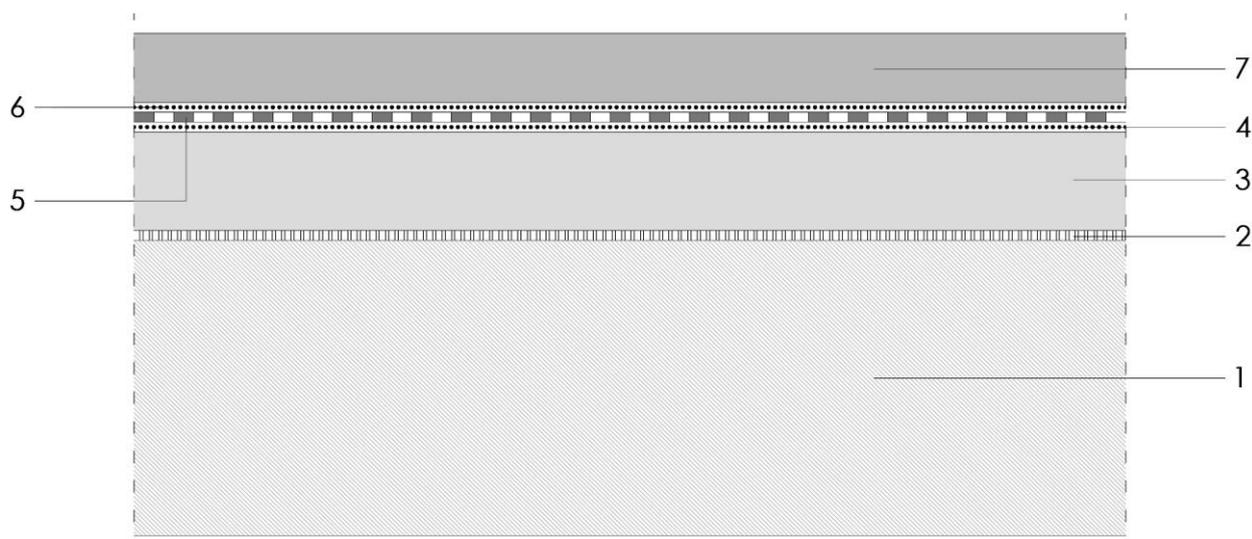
Detalle constructivo de cubiertas aparcamiento.
